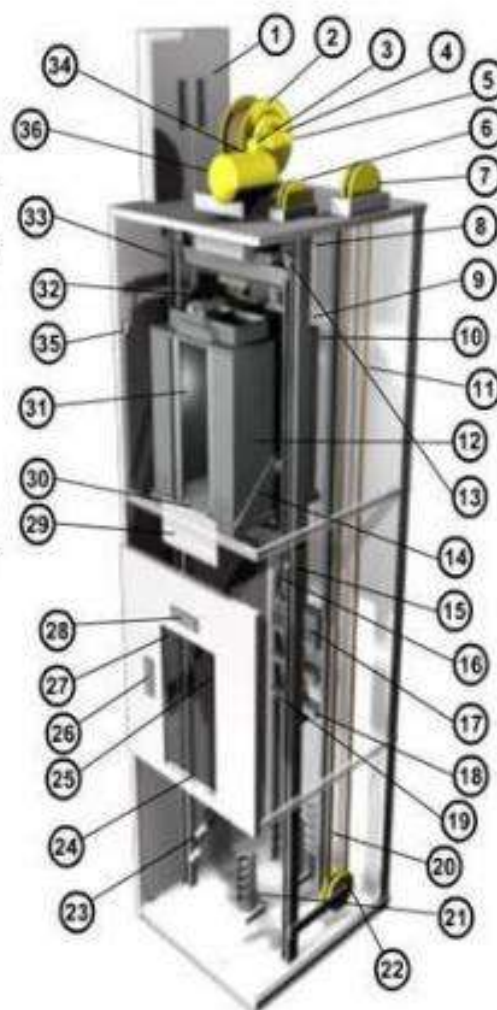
Partes do elevador (Fonte: Vetra Elevadores. Disponível em: <<https://vetraelevadores.com.br>>. Acesso em: 29 abr. 2017)
